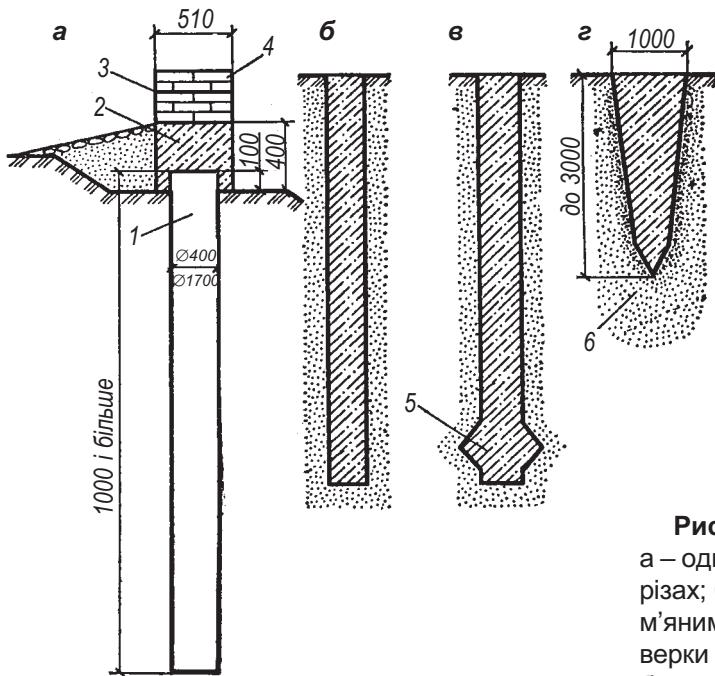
Набивні палі та фундаменти у витрамбуваних котлованах:
